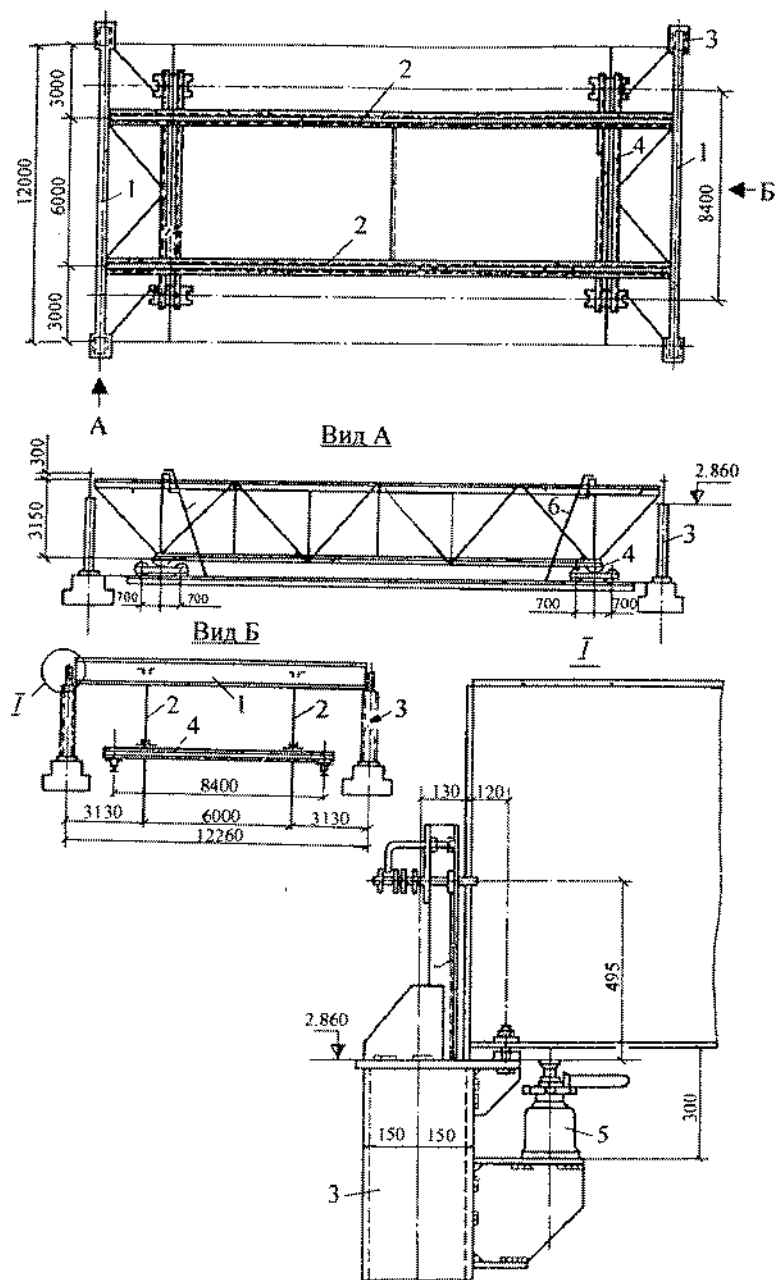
Кондуктор для сборки блока покрытия на первой стоянке конвейера:
